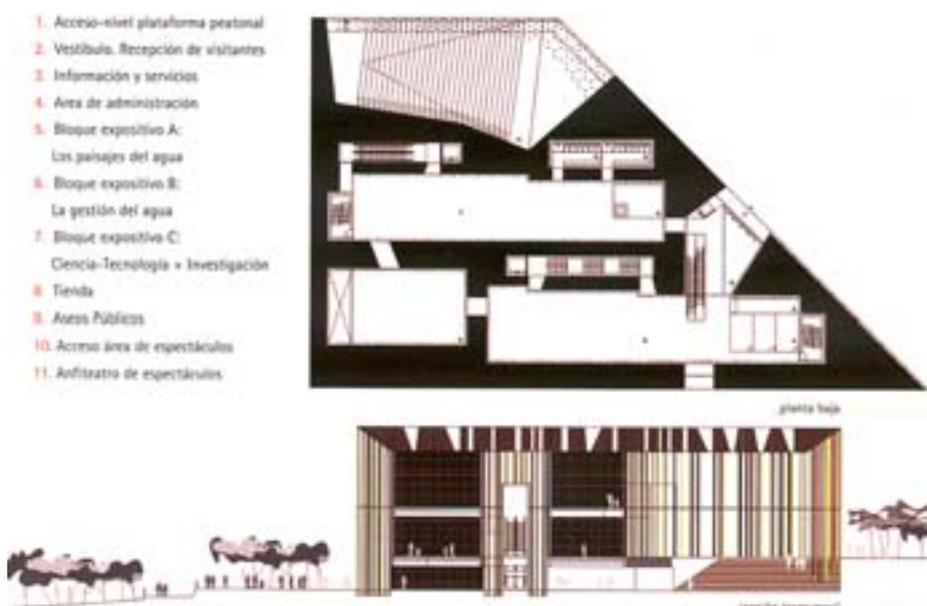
Pabellón de España, *planta y sección* (Francisco Javier Mangado y Cener).
